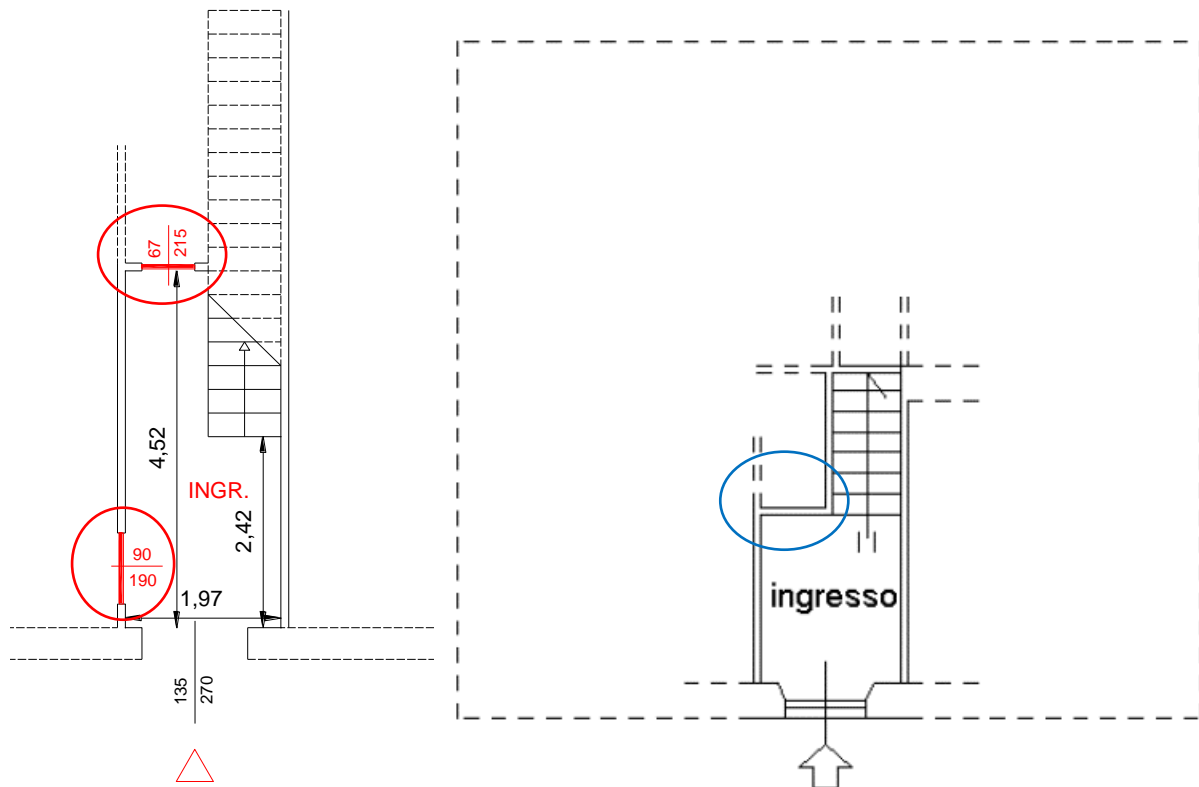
Raffronto planimetria da rilievo e planimetria catastale – PIANO TERRA
